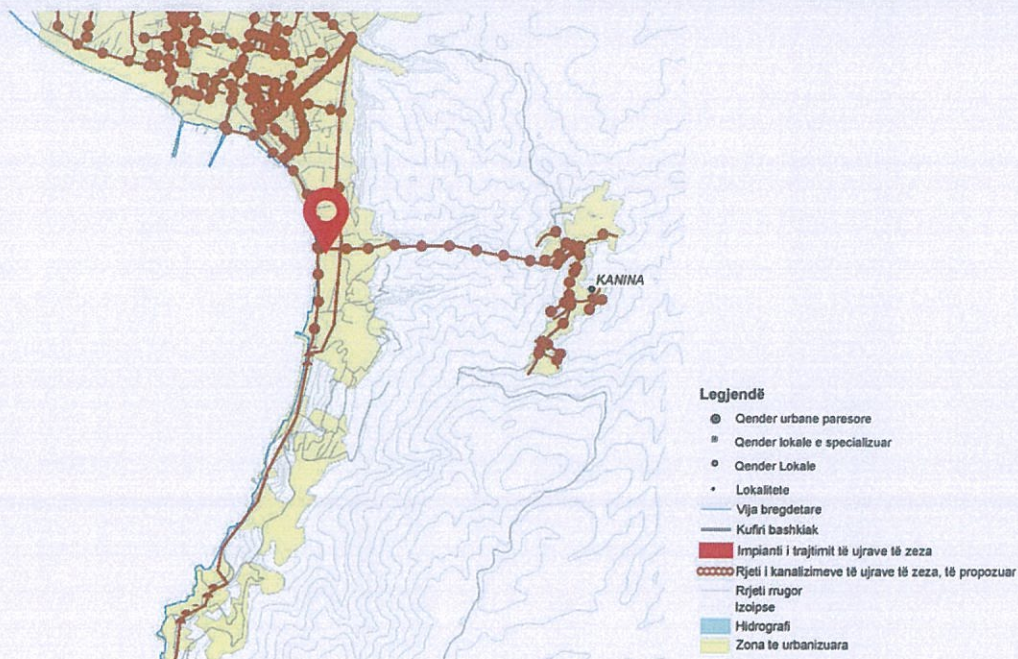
Plani i rrjetit të kanalizive të ujërave te zeza
